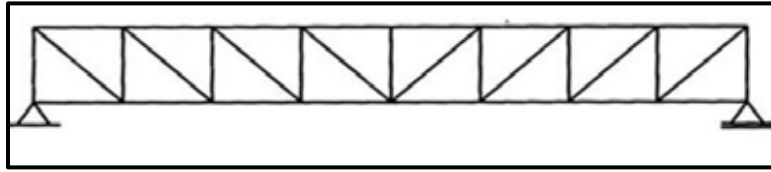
Viga metálica tipo PRATT. Fuente: http://www.construmatica.com/construpedia/Viga_Pratt (2015)
